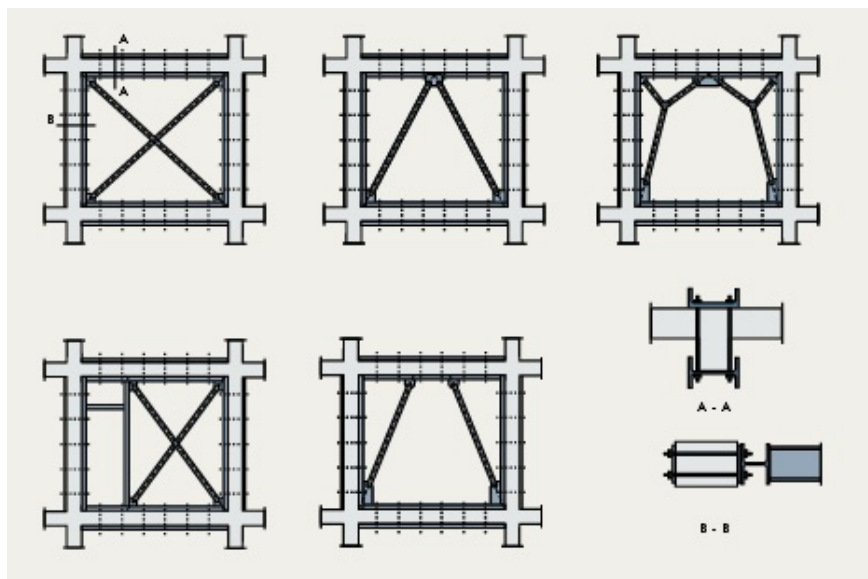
Ausfachung von Mauerwerksbauten mit Stahlrahmen – Arcellormittel [52]
